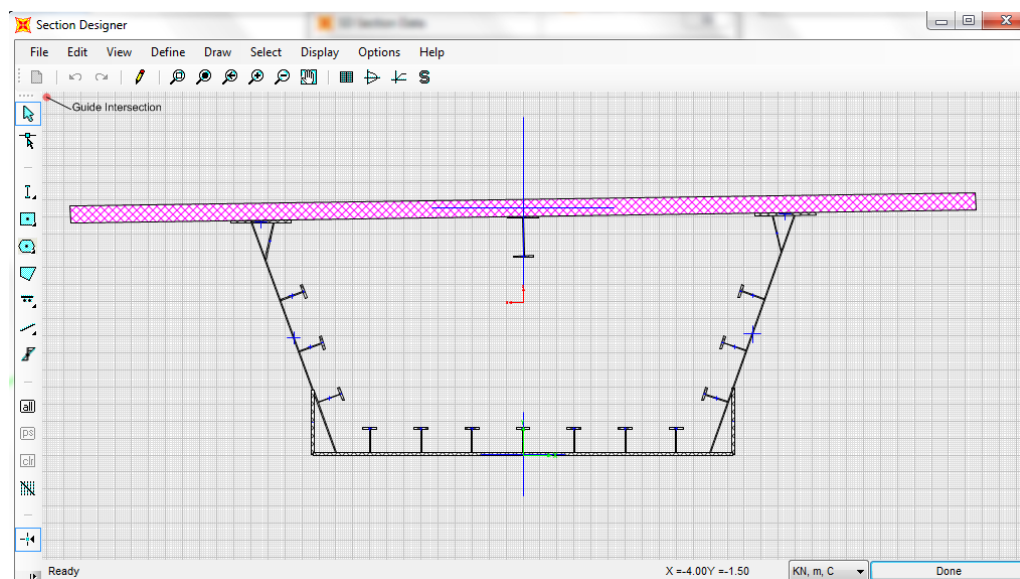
Modelo 1 en SAP2000, ingreso de la sección mixta de la superestructura
